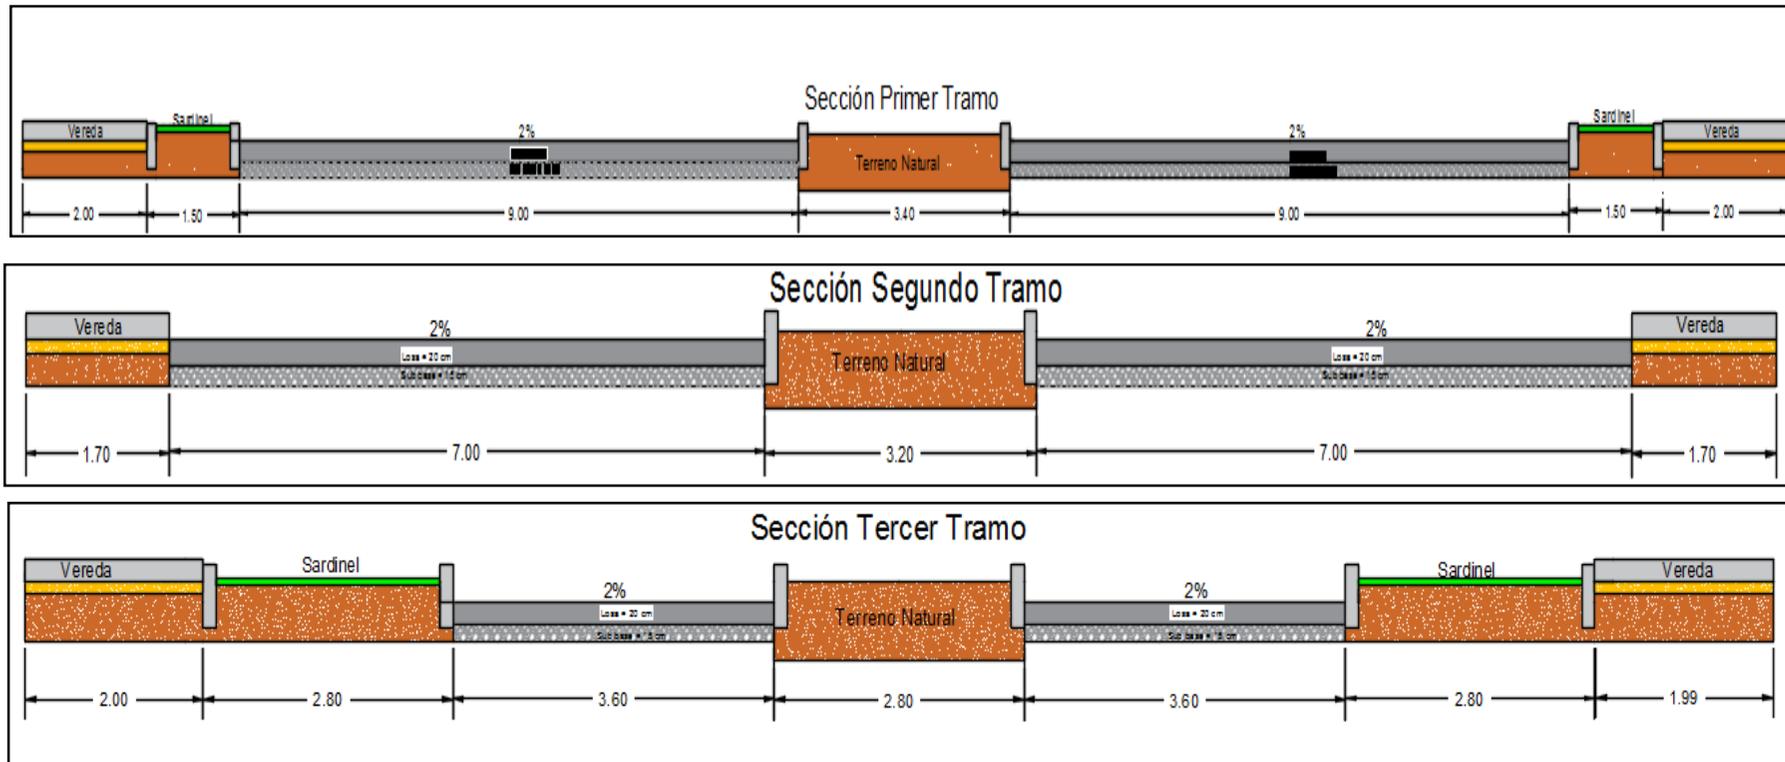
Sección transversal de pavimento flexible con su cunetas rectangulares de drenaje pluvial.
